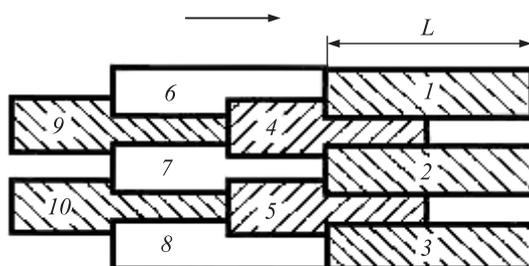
Шахматно-ребристая схема разработки грунта скрепером:
